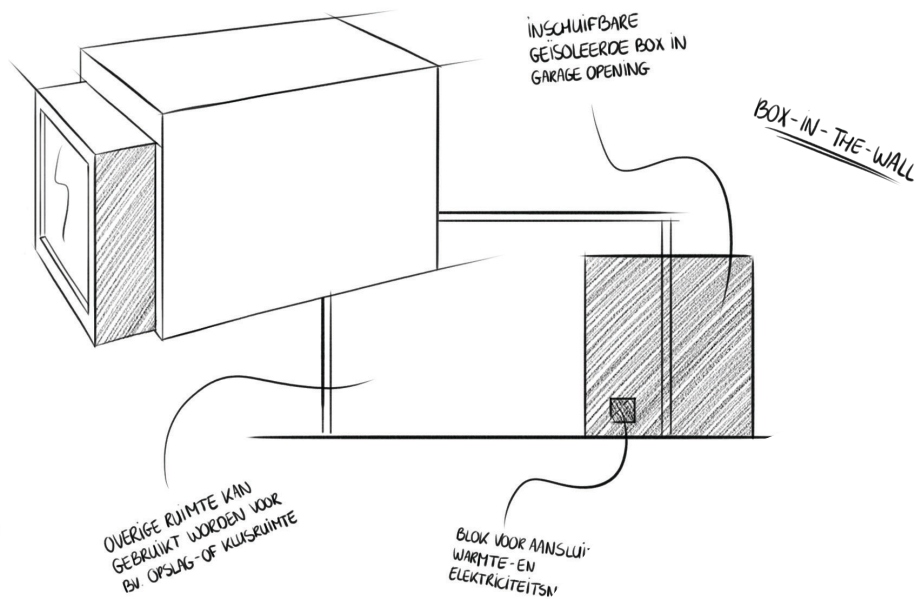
> VERVANGBARE WANDELEMENTEN UIT CONCEPT 1
